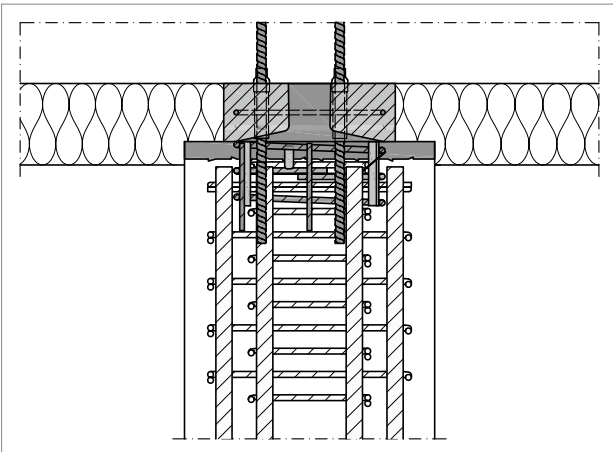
Schöck Sconnex® type P: Wapening in zone 2 - lengteprofiel van de kolom
